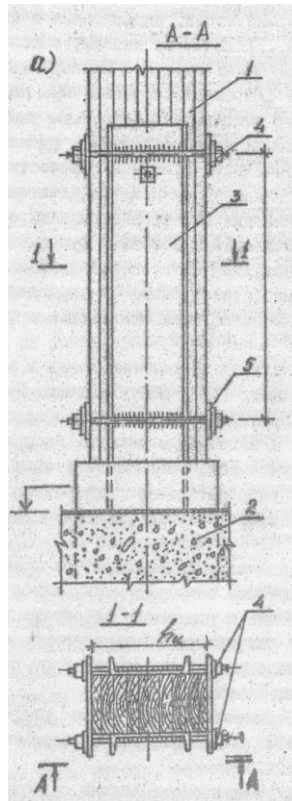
Жесткий узел сопряжения деревянной клееной стойки с фундаментом с помощью парных стальных пасынков:
